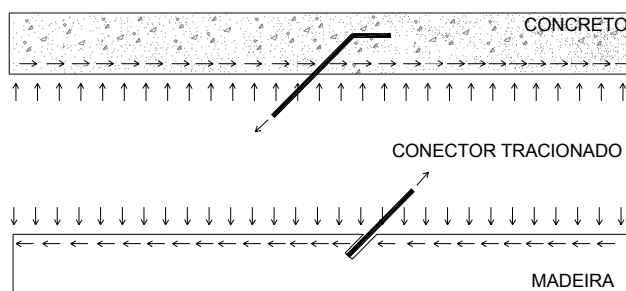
Solicitação no plano de interação da estrutura mista. Fonte: Modificado de PIGOZZO (2002).
